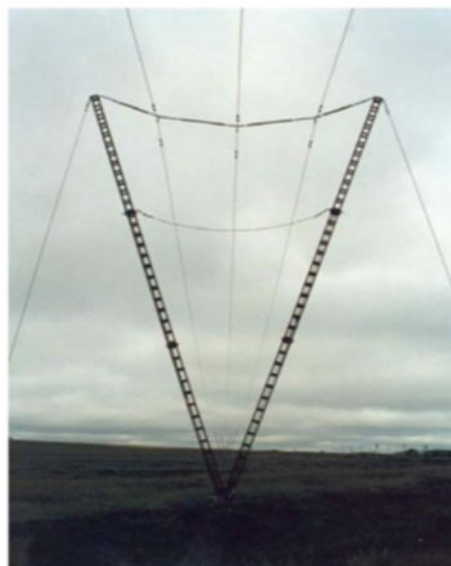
Опора с полимерной траверсой для воздушных линий напряжением 110 кВ
